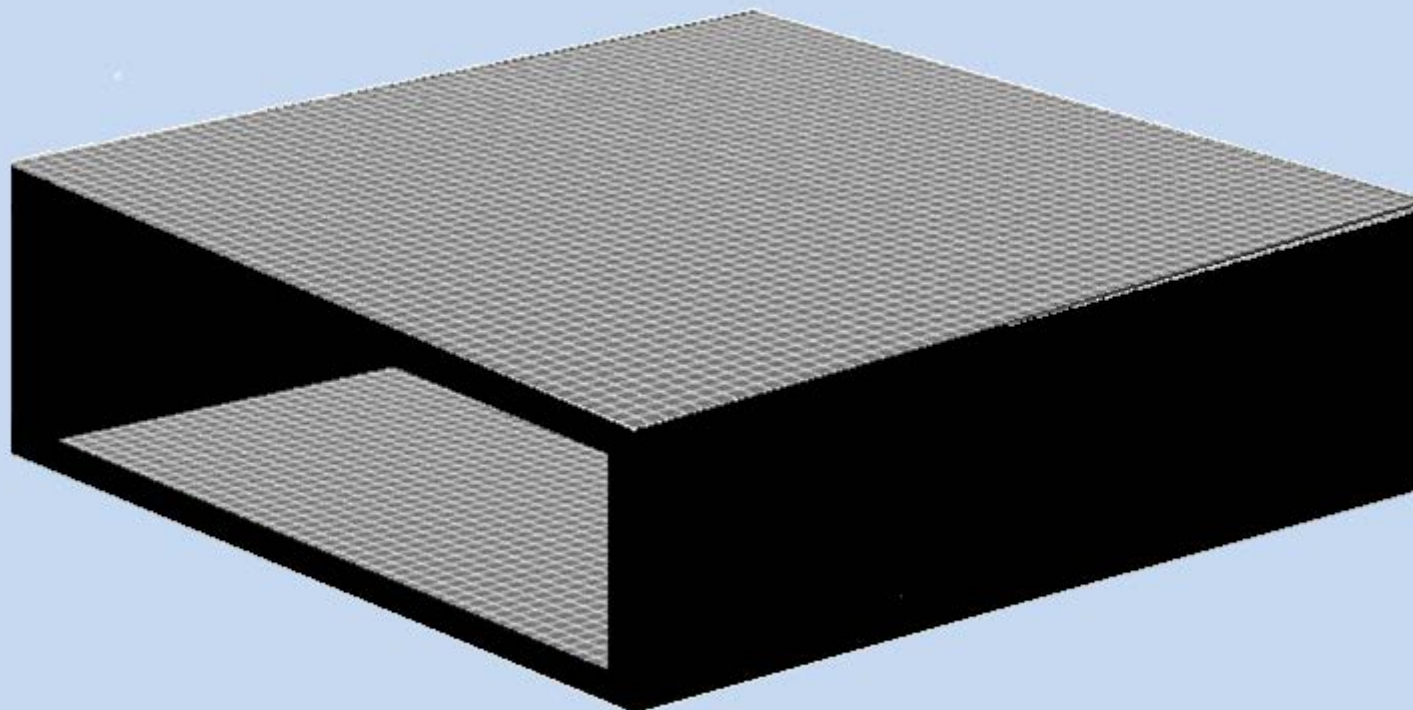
Верхняя (потолок) и нижняя (пол) железобетонные плиты подвала в здании «Максима». Упругая конструкция из плит в положении устойчивого равновесия.
